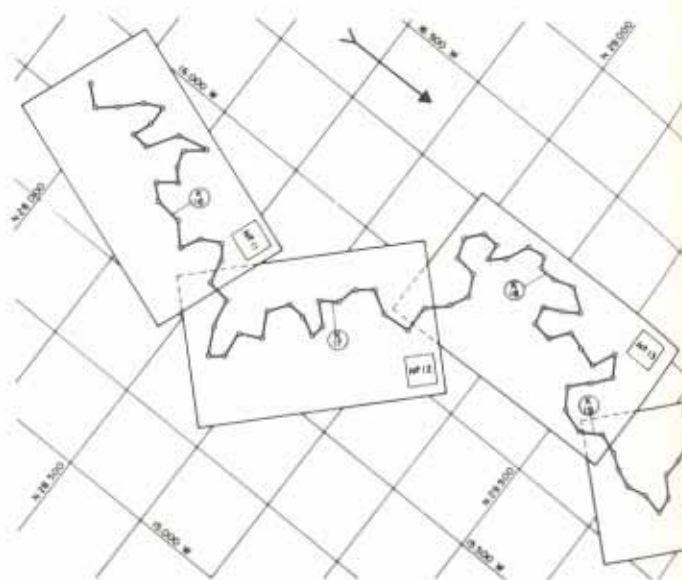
Disposición de las láminas de planta sobre un plano de conjunto.
